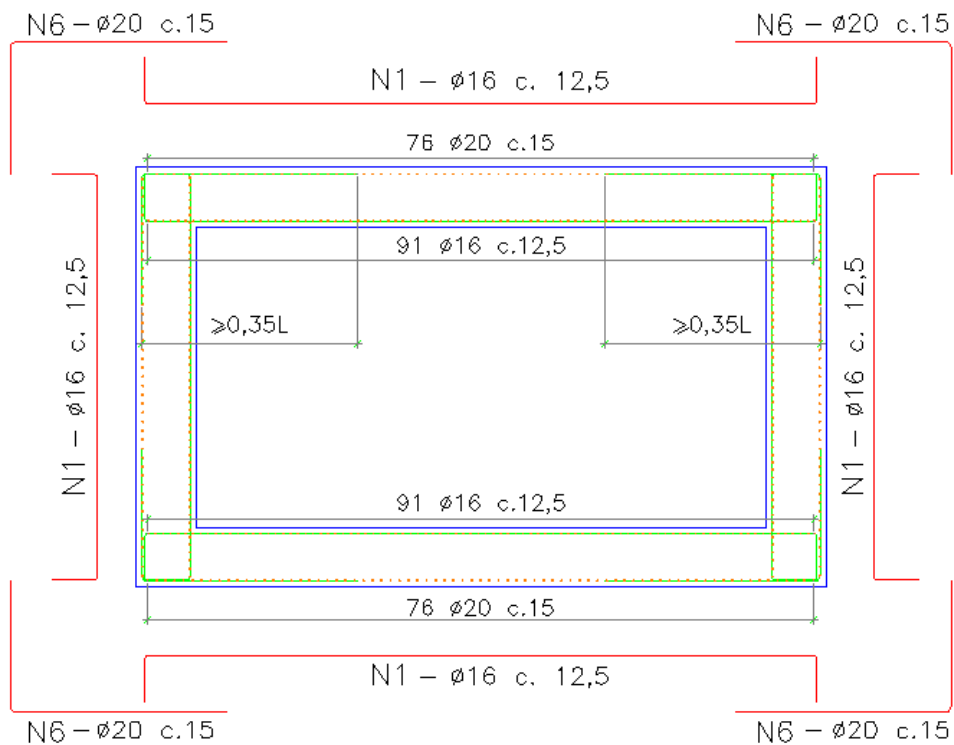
Esquema das armaduras nas seções sem pilar central
